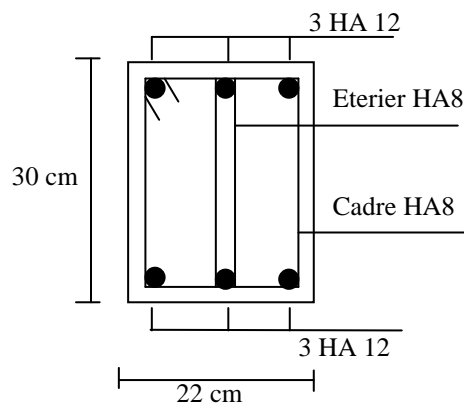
Schéma de ferrailage de la poutre de chaînage.
